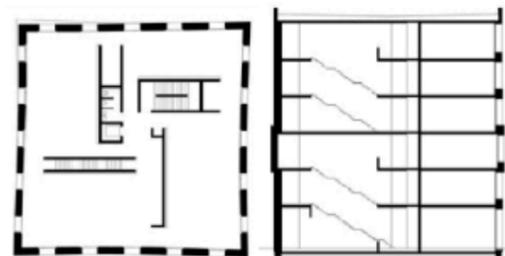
Grundriss Regelgeschoss und Schnitt
